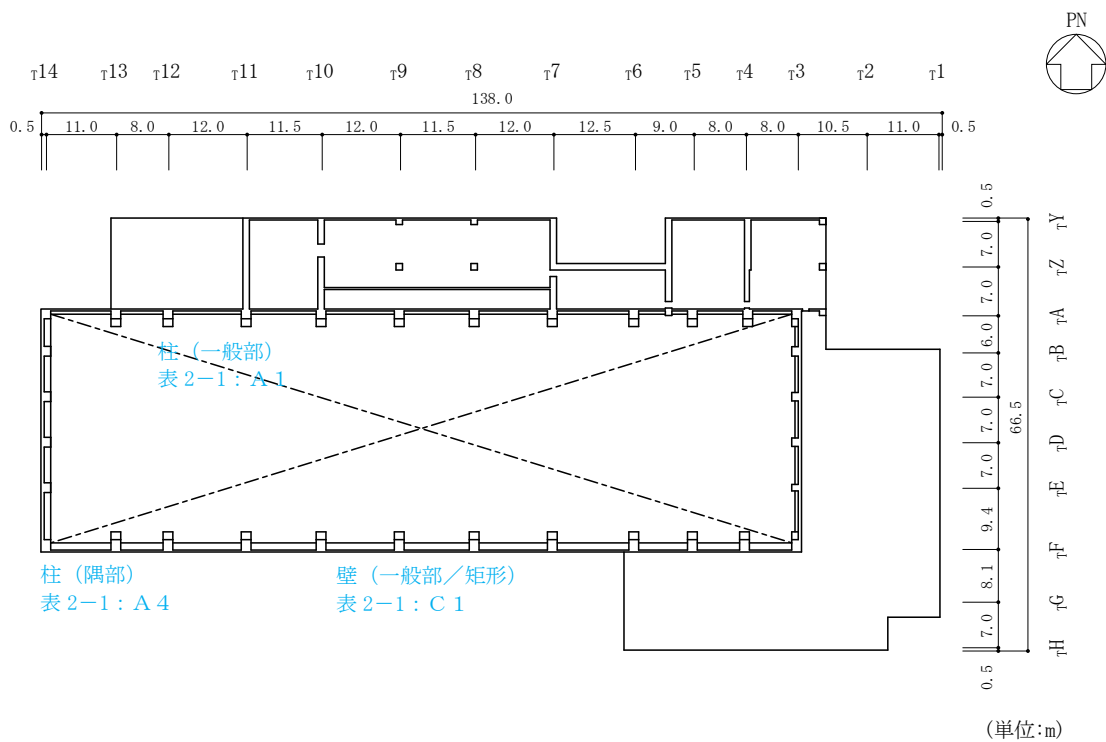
(5) タービン建物の概略平面図 (EL 32.0m)
